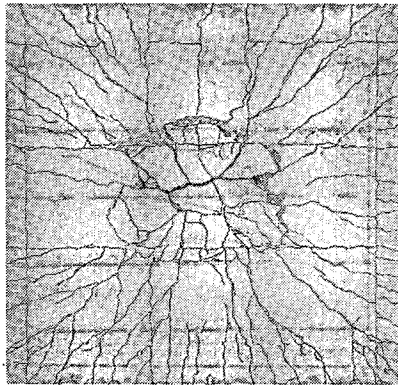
普通鉄筋コンクリート2方向床版のひびわれ状態 (鉄筋ピッチ 30 cm)
